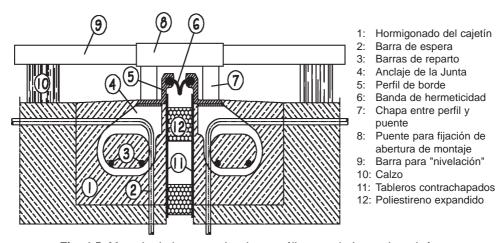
Montaje de junta con bordes metálicos anclados en hormigón.
